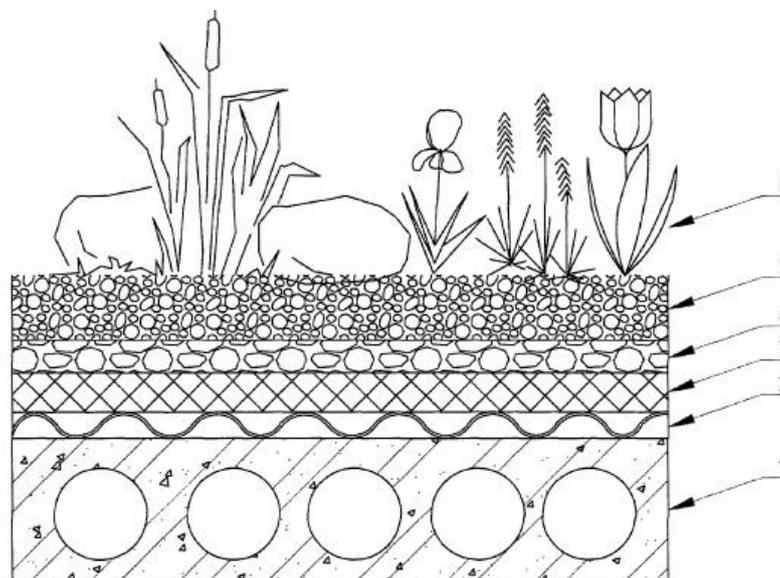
Конструкция зеленой кровли, предназначенная для жилых зданий: 1 - железобетонная плита, 2. защитный слой - ондулин, 3 - теплоизолирующий слой из пенополистирола, 4 - фильтрующий слой из торфа и/или гравия, 5 - закрепляющая смесь грунта, 6 - растительный слой содержащий субстрат с растениями.
